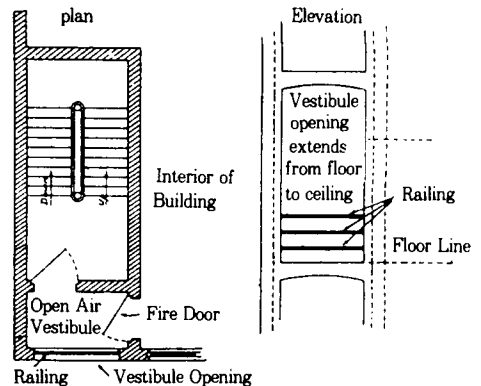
권장 Building Code 1915에 나오는 Smokeproof tower
